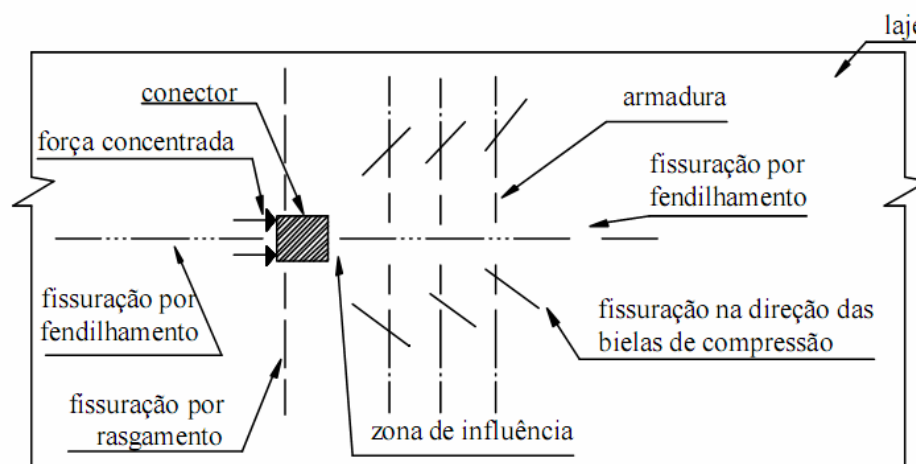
Tipos de fissuração na laje – TRISTÃO (2002)
